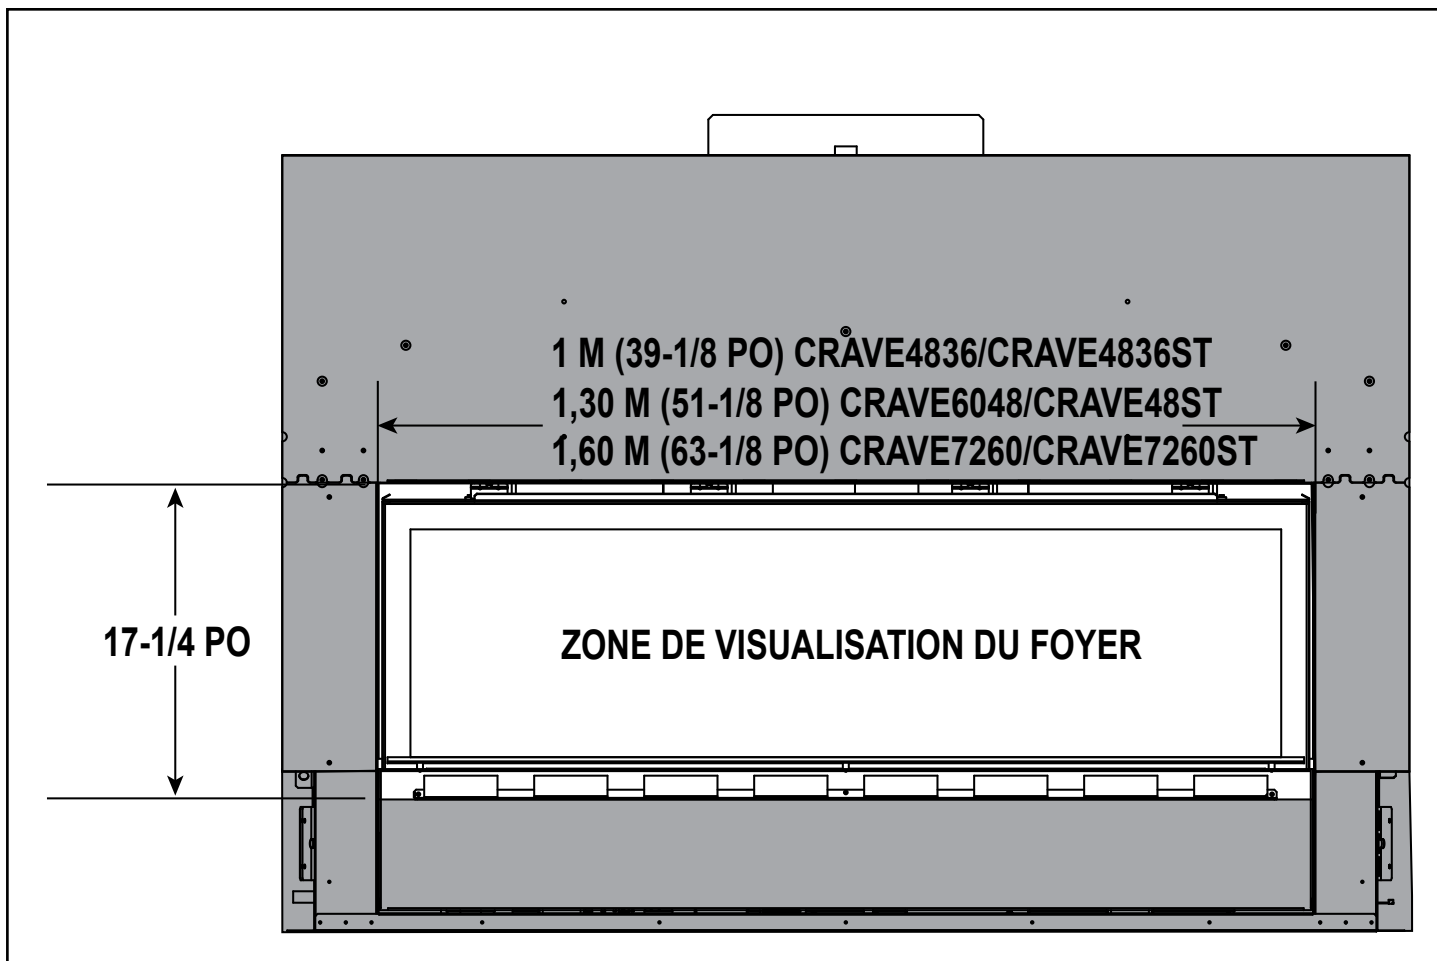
Dimensions de l'ouverture finie - méthode d'ajustement superposé
